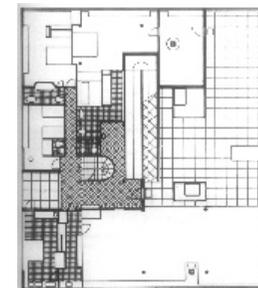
Le Corbusier, Ville Savoye, Planta baixa do segundo pavimento.
